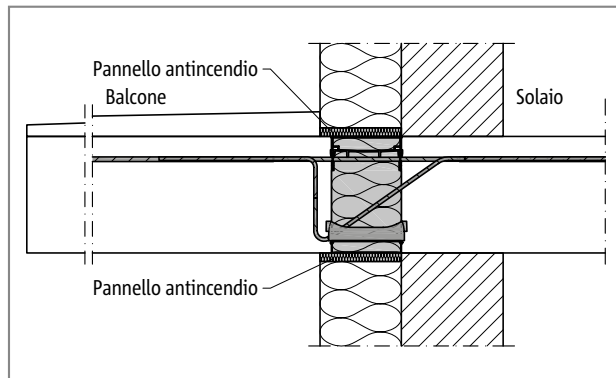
Schöck Isokorb® tipo KXT-R0: configurazione REI30 nel sistema di isolamento a cappotto con strato isolante minerale
